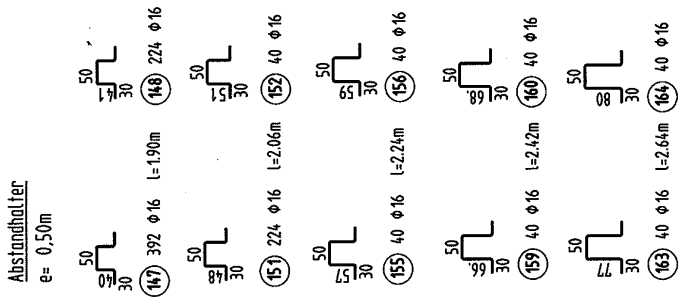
Auszug einer Konstruktionszeichnung eines Brückenüberbaus mit den Biegeformen 06 und 32, die sich alle im Aufbau prinzip widersprechen.
